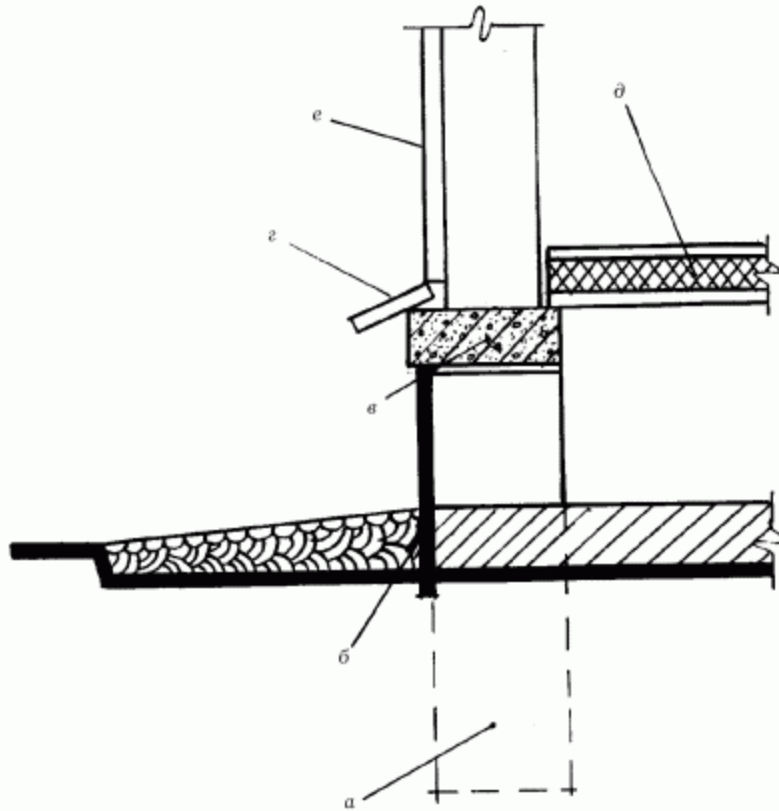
Устройство столбчатого фундамента в доме с теплым полом: а – фундаментный пол; б – забирка; в – железобетонная перемычка; г – сливная отстойка; д – теплый пол; е – стена.
